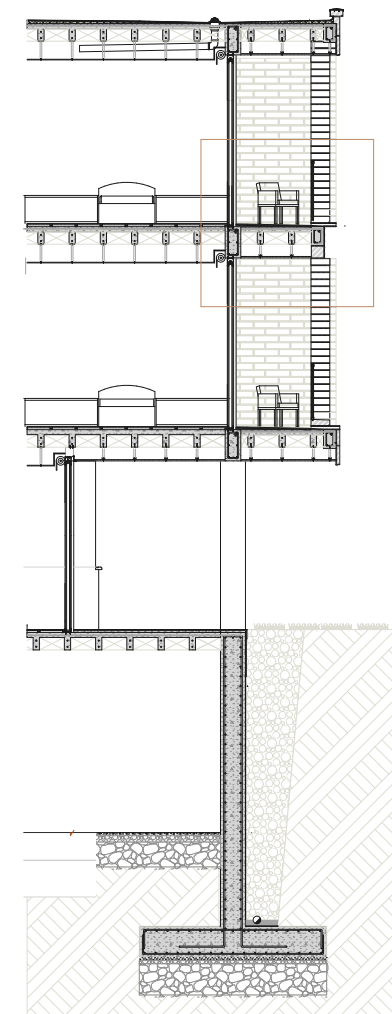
Sección constructiva. Fuente: Autoría propia.
